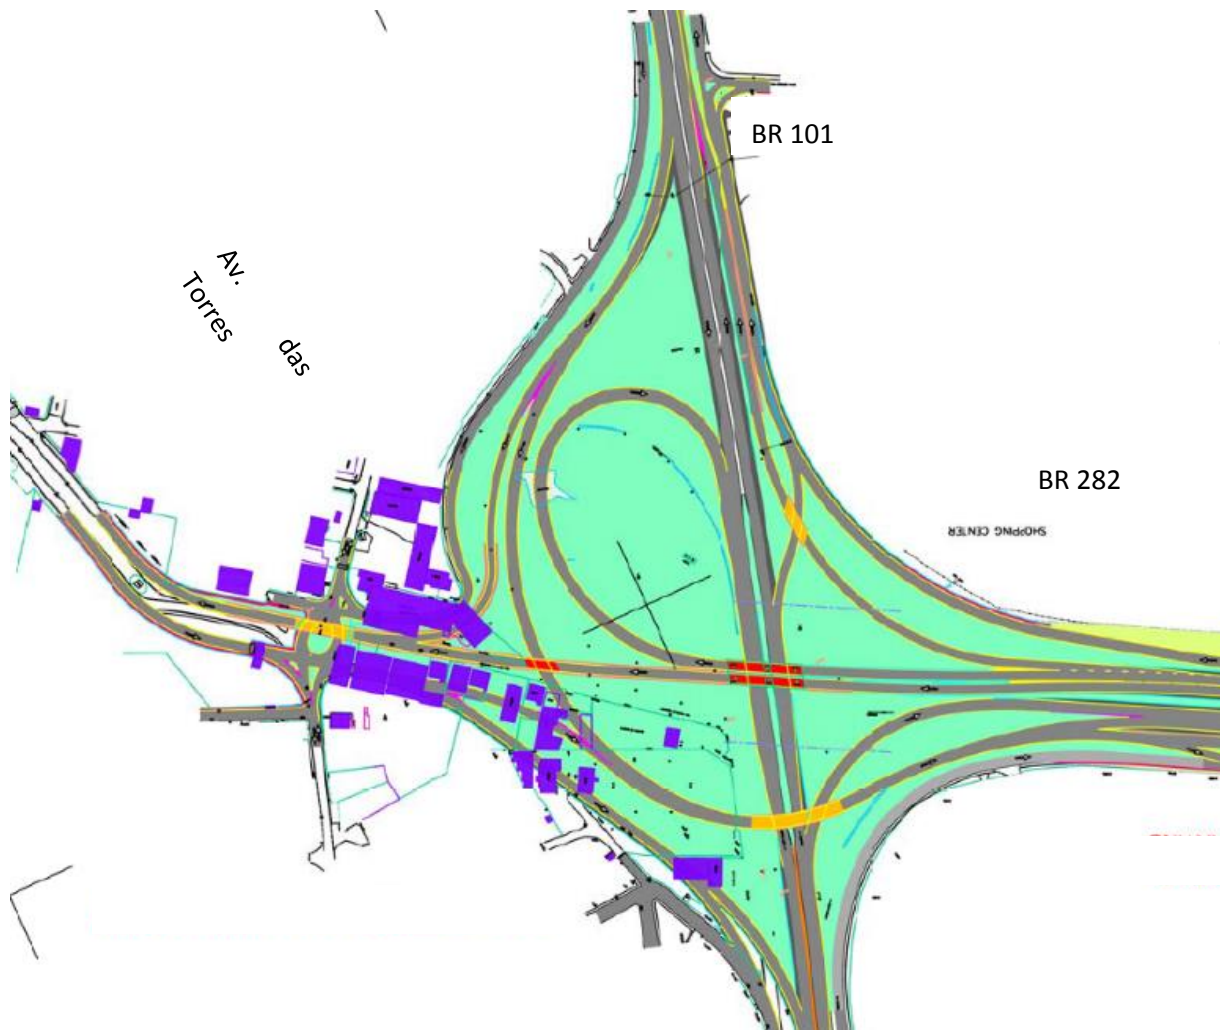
Projeto existente para trevo entre BR-101 e BR-282, em São José, com ligação da BR-282 à Av. das Torres.
